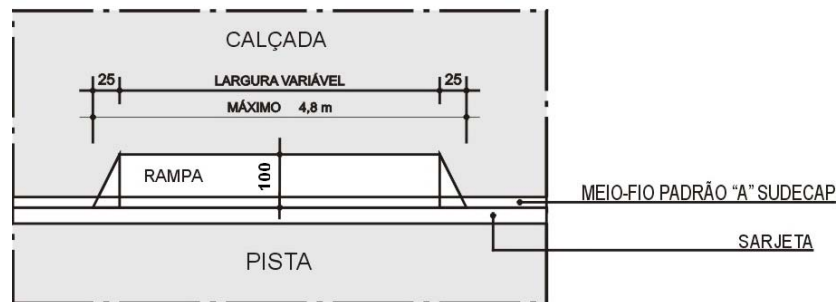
Planta de rebaixo padrão para acesso de troca de óleo e lavagem.
